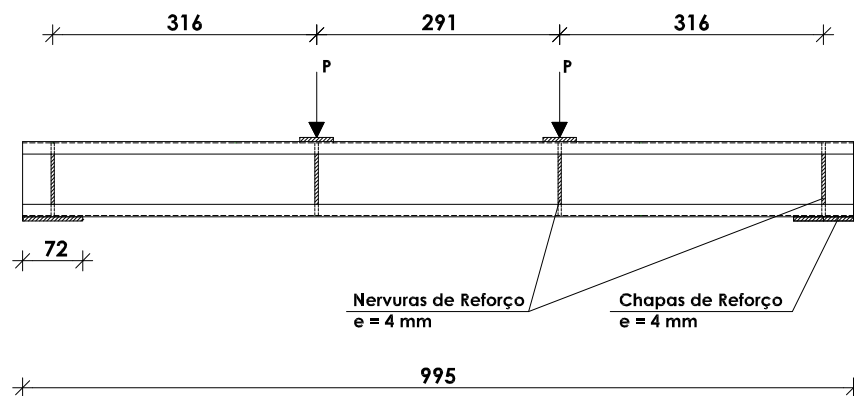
Alçado do ensaio tipo 90×1.5\_Fyy\_Furos (dimensões em mm).
